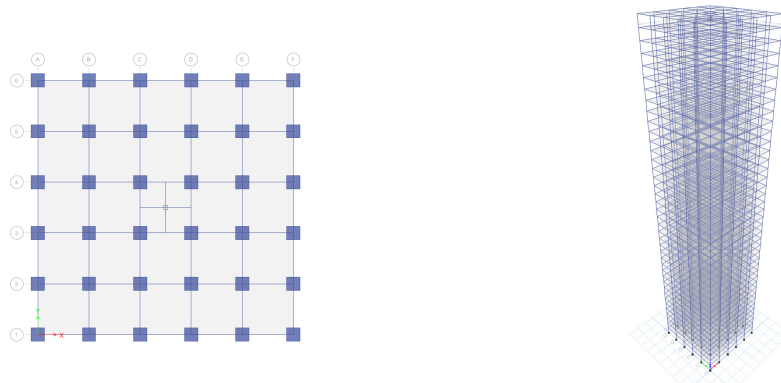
Structura cu cadre din b.a. avand forma patrata - plan si elevatie
